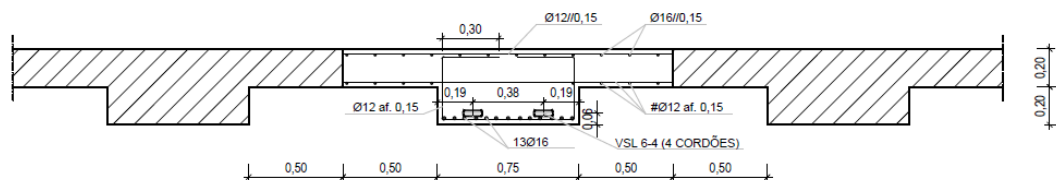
Laje nervurada do auditório e laje vigada da cobertura.
